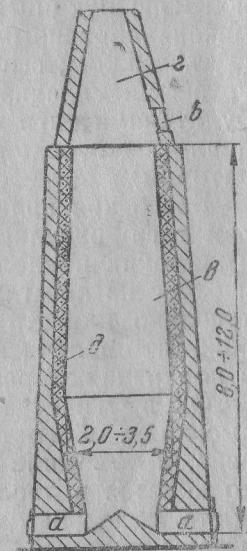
а — окна для выгрузки извести; б — окно для загрузки известняка; в — шахта; г — дымовая труба; д — футеровка шахты.
